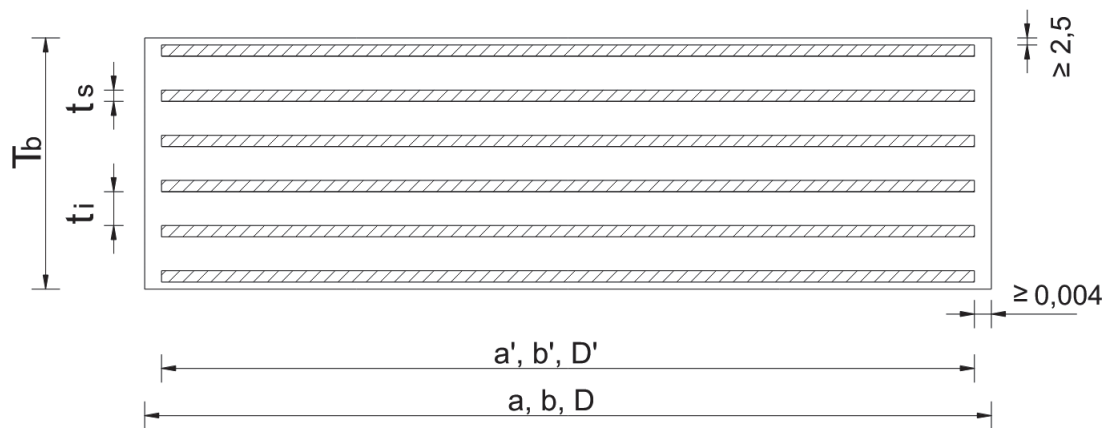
Sección transversal típica de un apoyo elastomérico tipo B
